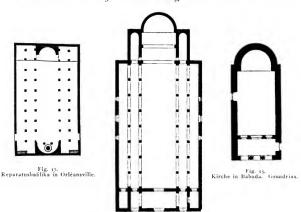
Baūlika in Suweda. Grundriss.
